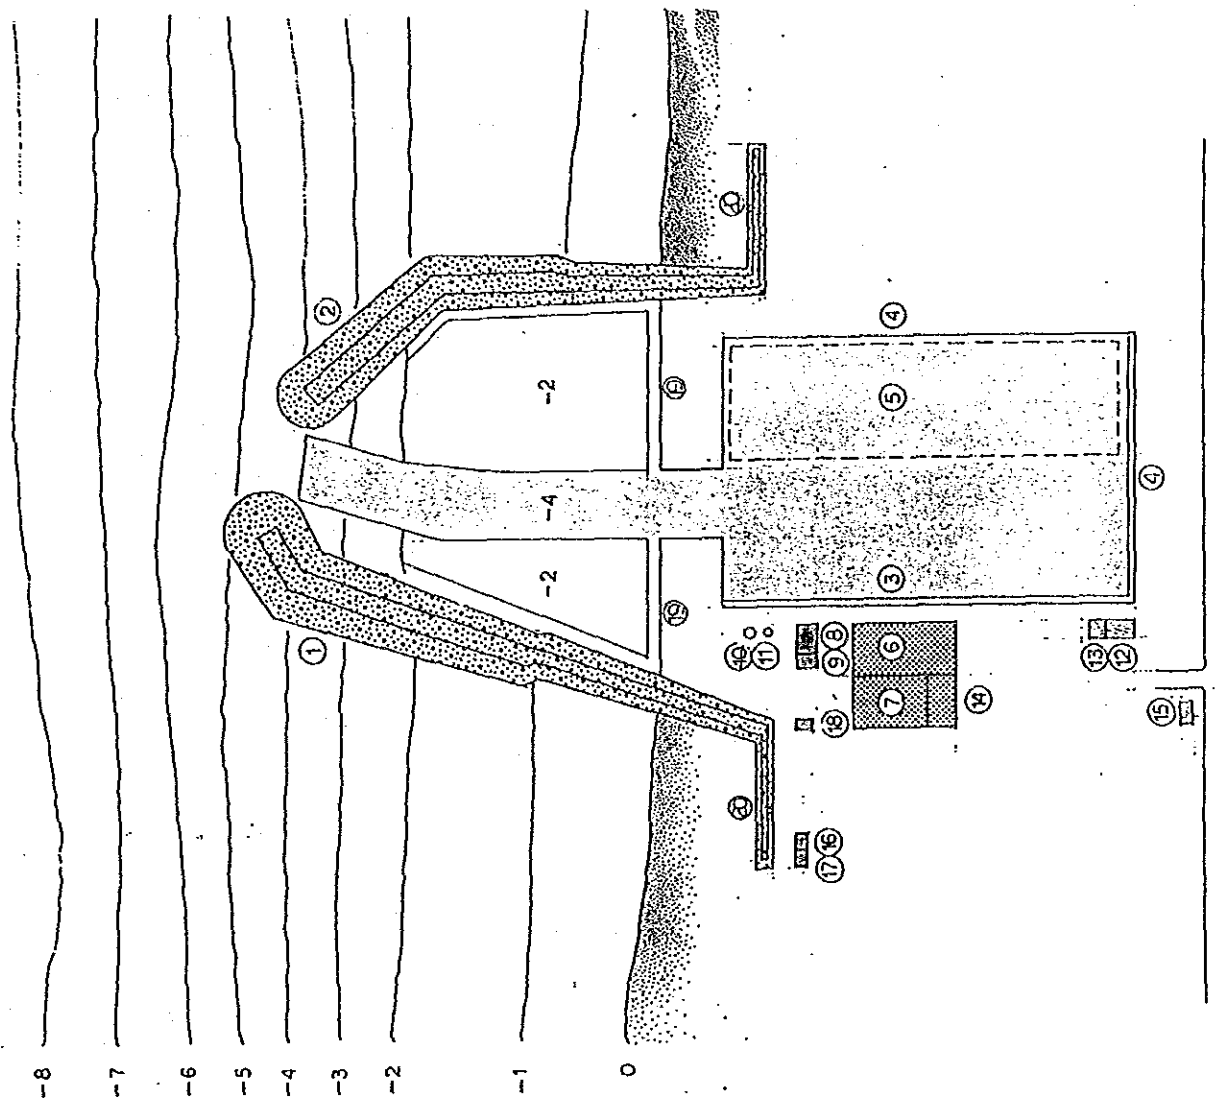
Plan de disposición del proyecto de desarrollo a corto plazo
